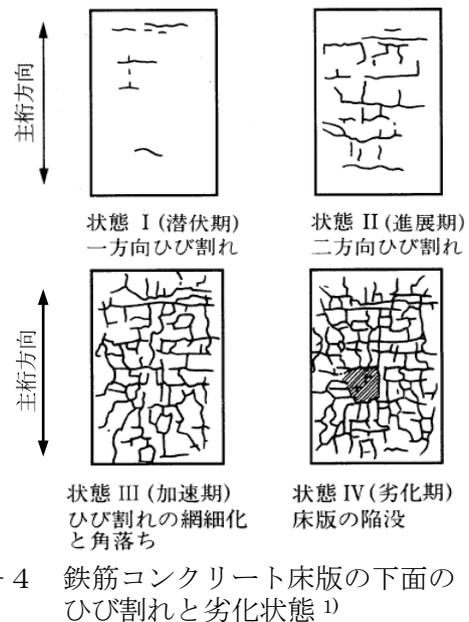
鉄筋コンクリート床版の下面のひび割れと劣化状態¹⁾
